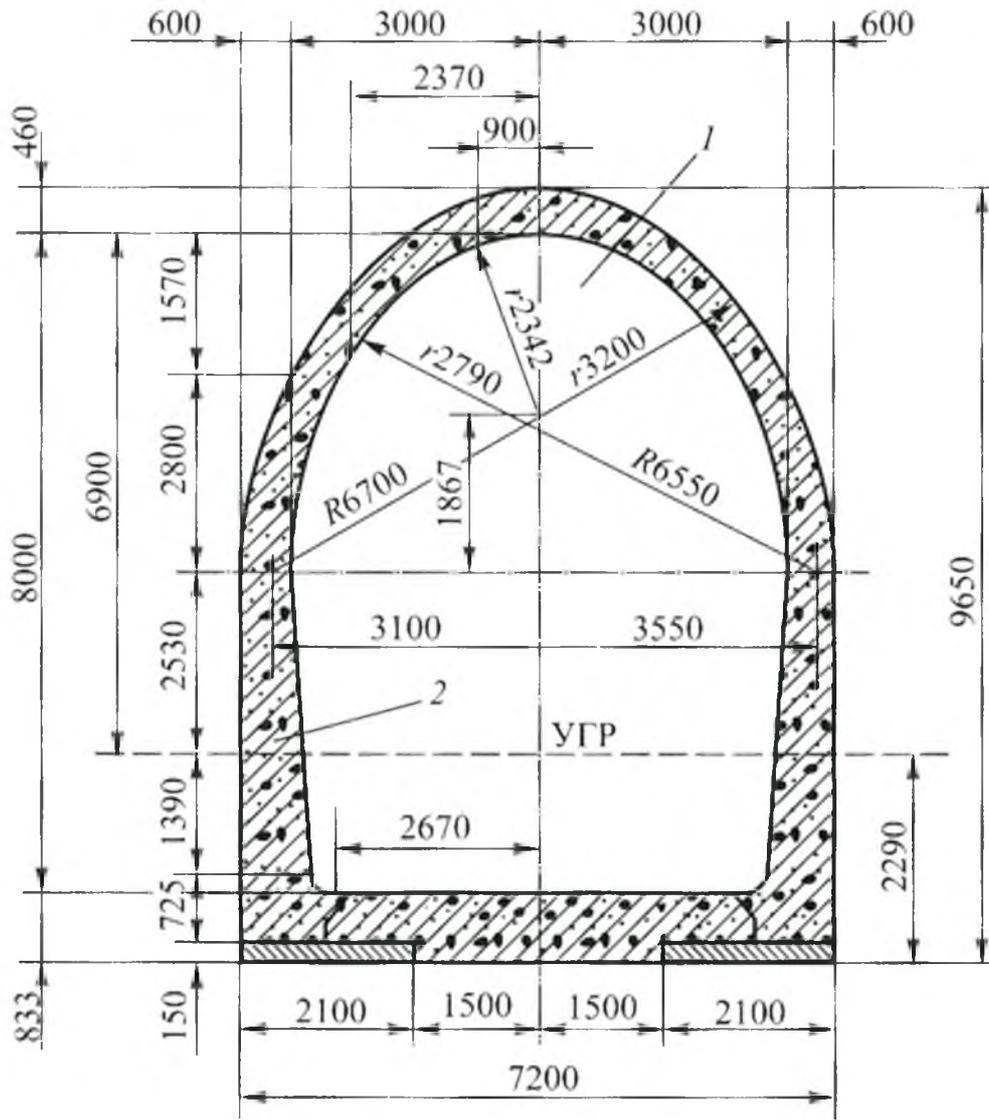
Конструкция монолитной бетонной обделки без обратного свода:
